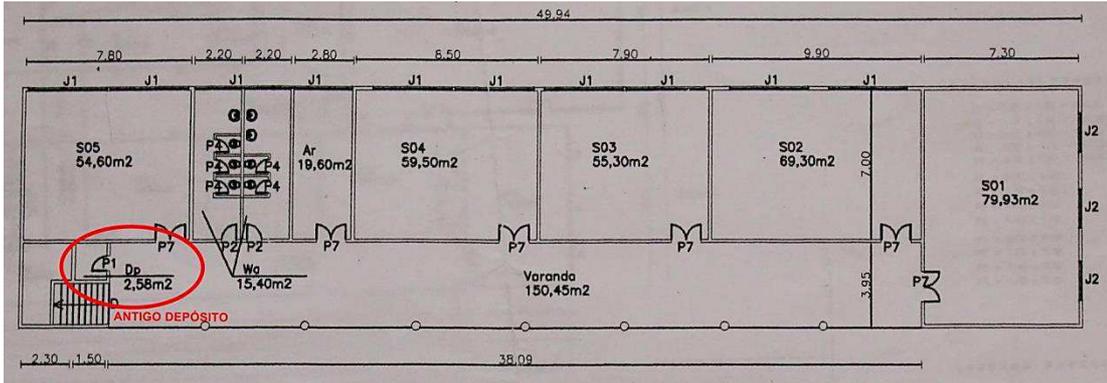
Planta baixa do Pavilhão Ernesto Simões Filho (1º andar)
